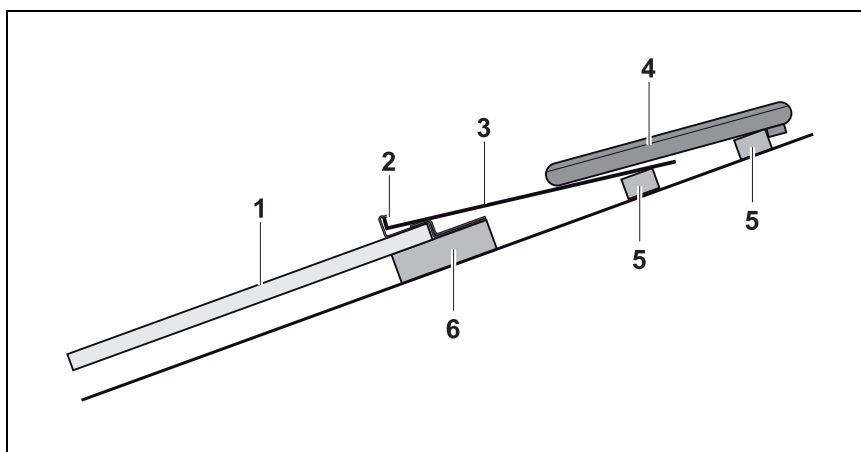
Raccordement de toiture sur un toit de tuiles (vu d'en haut)
